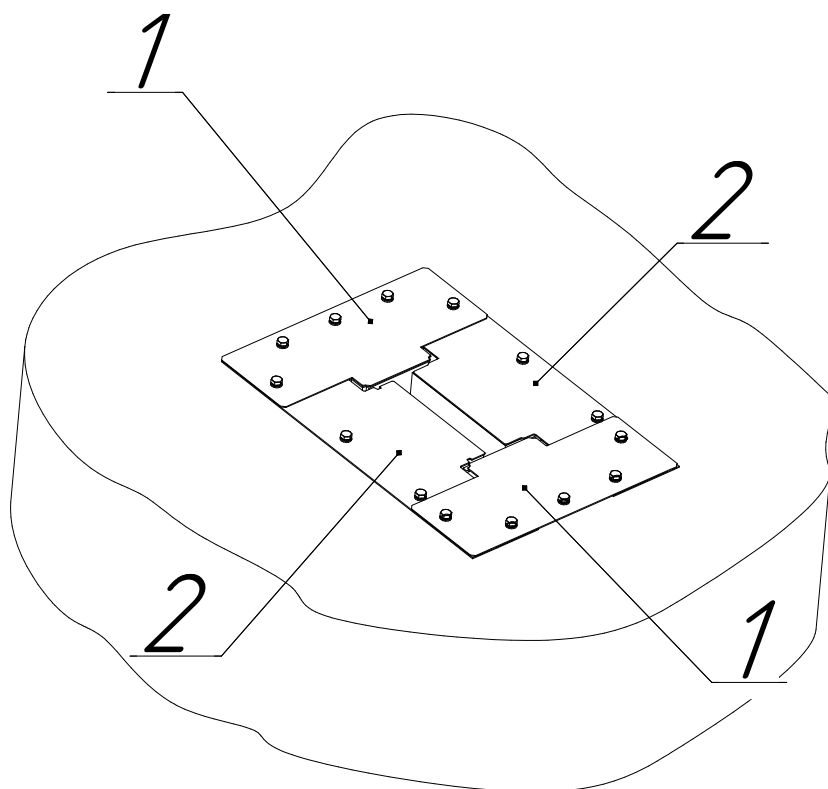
Схема крепления декоративных пластин для закрытия отверстия в перекрытии: 1 – фронтальные нижняя и верхняя пластины; 2 – боковые пластины.
